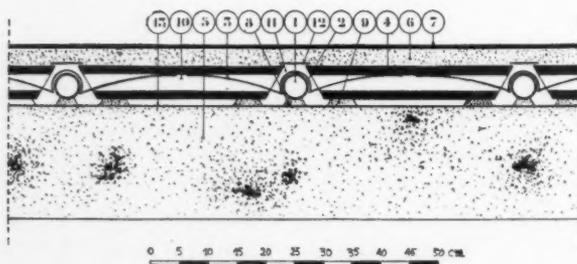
COUPE TRANSVERSALE SUR UN PLANCHER CHAUFFANT:
